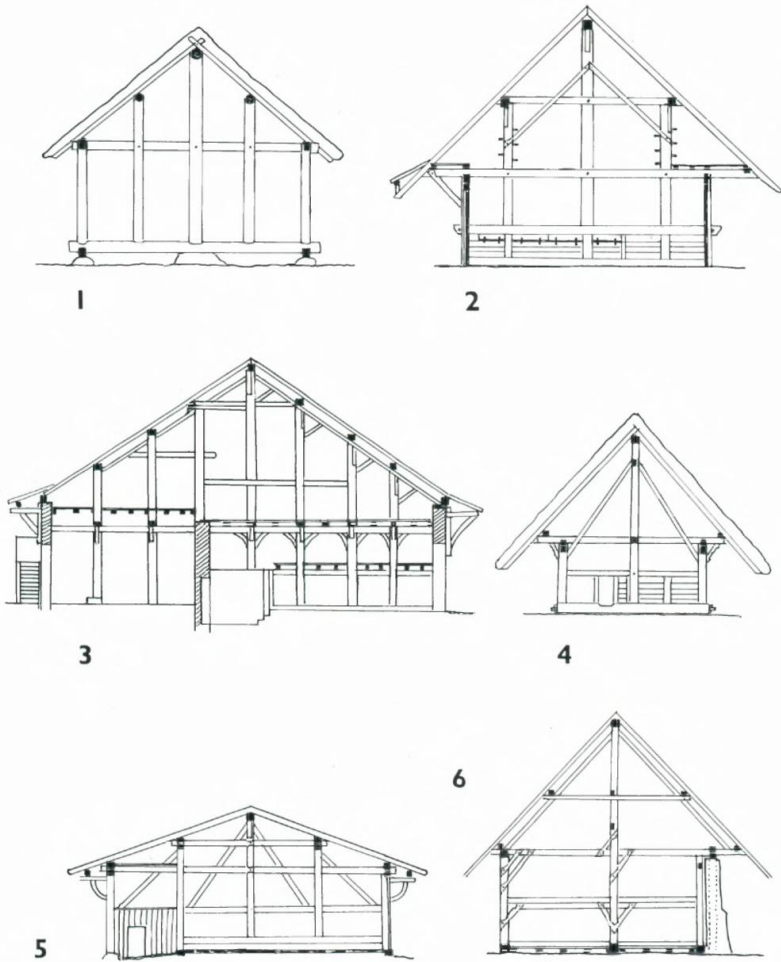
SAULENPFETTENDÄCHER haben Dachgerüste, deren waagrechte, längsgerichtete Dachbalken („Pfetten“) von durchgehenden Hochsäulen getragen werden. Bei ihnen sind zumindest in den wichtigsten, aufgehenden Elementen Hausgerüst und Dachgerüst noch identisch: 1. Dreschscheune mit First- und Nebensäulen im Querschnitt aus Uttorpet, Slädene sn., Västergötland, Schweden (nach S. Erixon). — 2. Sog. dreireihiger Hochsäulenbau mit Pfettenrofen-dach aus Gross-Bösingen, Kanton Fribourg, Schweiz (nach M. Gschwend). — 3. Wohnstallhaus mit Hochsäulen (Schnitt) aus Avusy-Sézegnin, Kanton Genf, Schweiz (nach M. Gschwend). — 4. Firstsäulen- oder Hochstudhaus (Schnitt) aus dem Schweizer Mittelland (nach M. Gschwend). — 5. Ständerbau mit Säulenpfettendach einer Innviertler Scheune (Schnitt) aus Riedlkam bei Lamprechtshausen, Salzburg (nach A. Klaar). — 6. Altbayerisches Firstsäulenhaus (Schnitt) in Honsolgen, Lkr. Kaufbeuren, Bayern. Schwaben (nach W. Neu).
